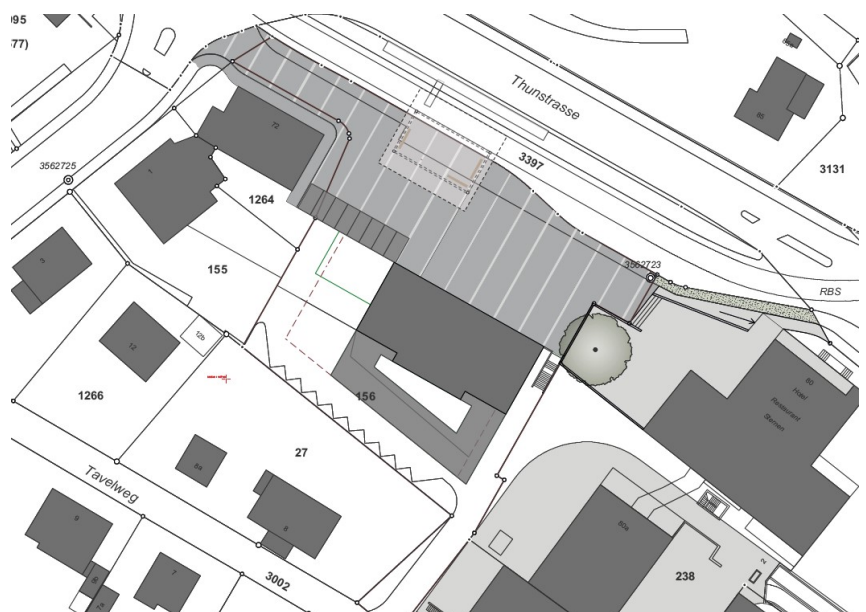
Situationsplan Machbarkeitsstudie, David Bosshard Landschaftsarchitekt
